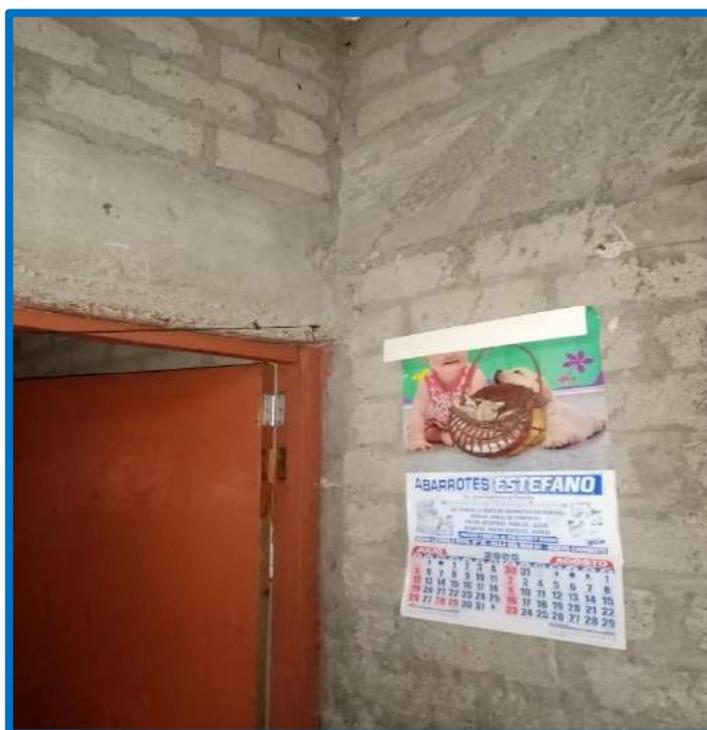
La viga no está amarrada a ninguna columna por ende esta sobre el muro generando una carga innecesaria, mal proceso constructivo. (Mz. 19 Lt.12)
